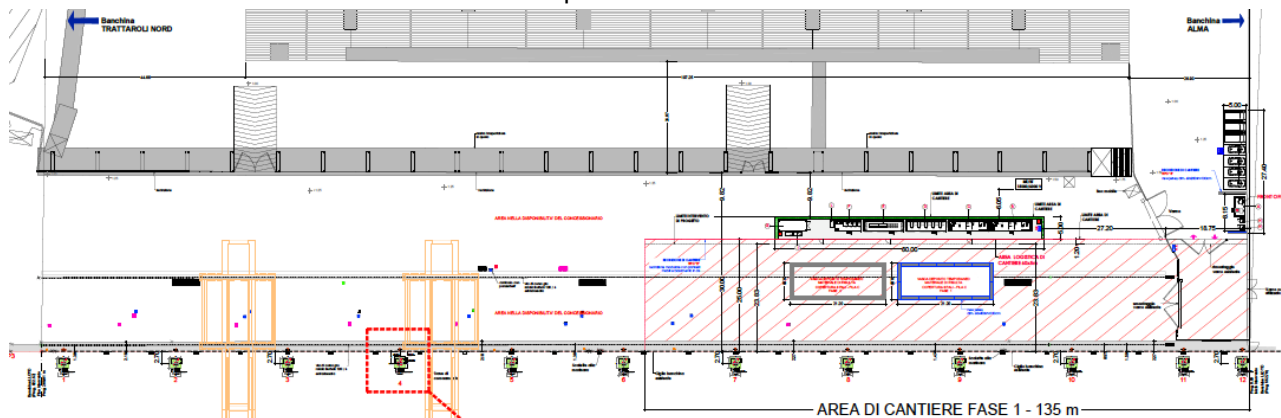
Banchina Lloyd – Area di cantiere Fase 1
